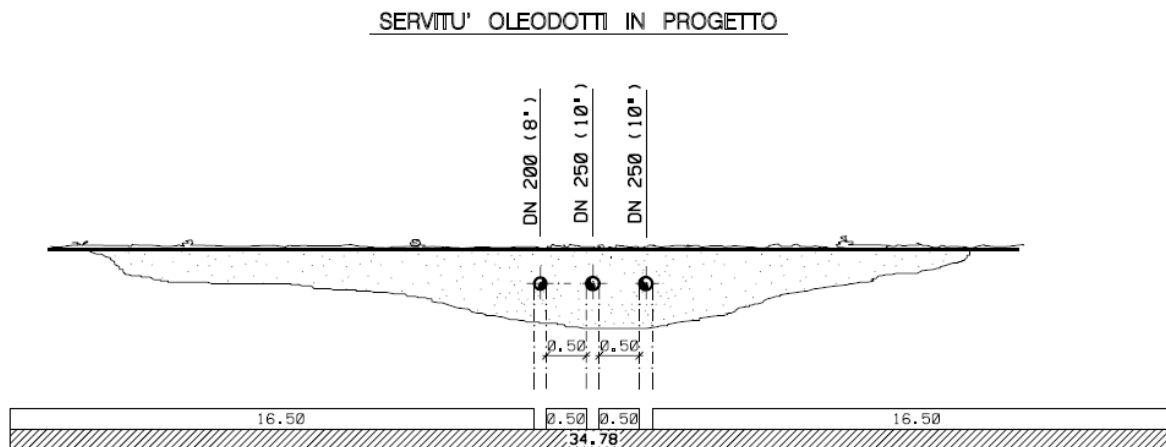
Individuazione della larghezza delle aree sottoposte a servitù non edificandi (Fonte: stralcio della planimetria catastale con fascia di asservimento – eni, emissione finale 27/06/2013)
